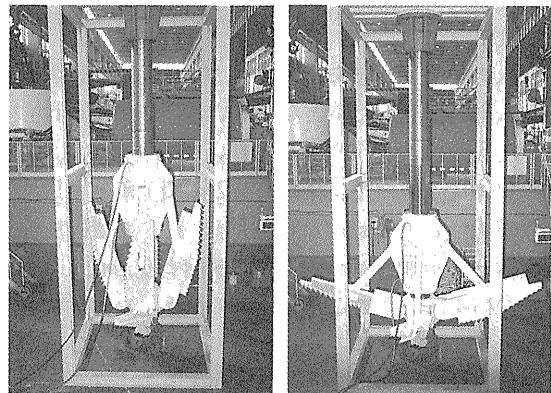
拡開カッタ（閉じた状態）写真-3 拡開カッタ（拡げた状態）
